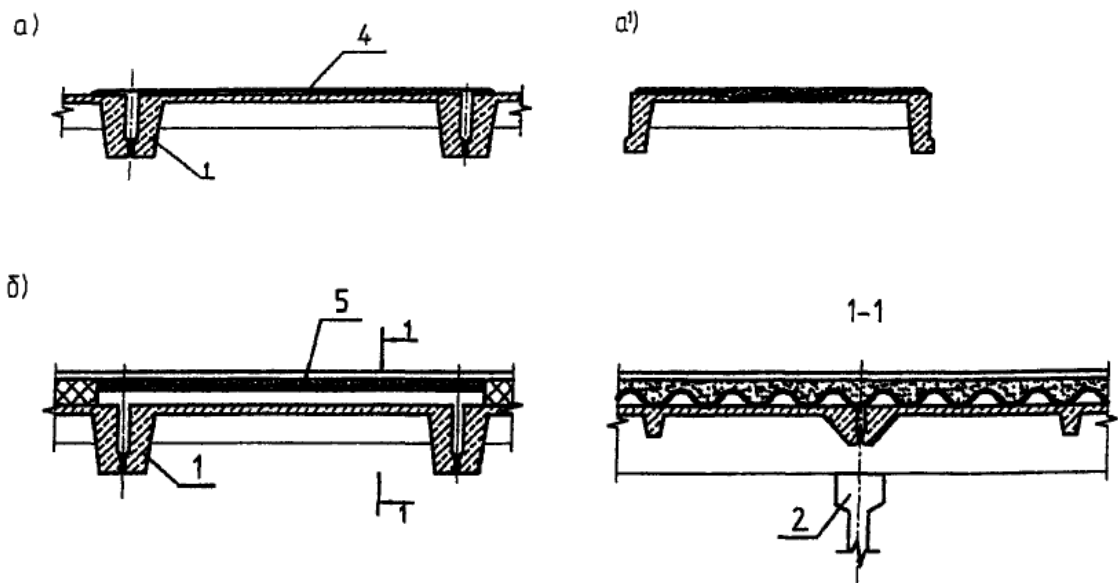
Усиление железобетонной ребристой плиты покрытия наращиванием
